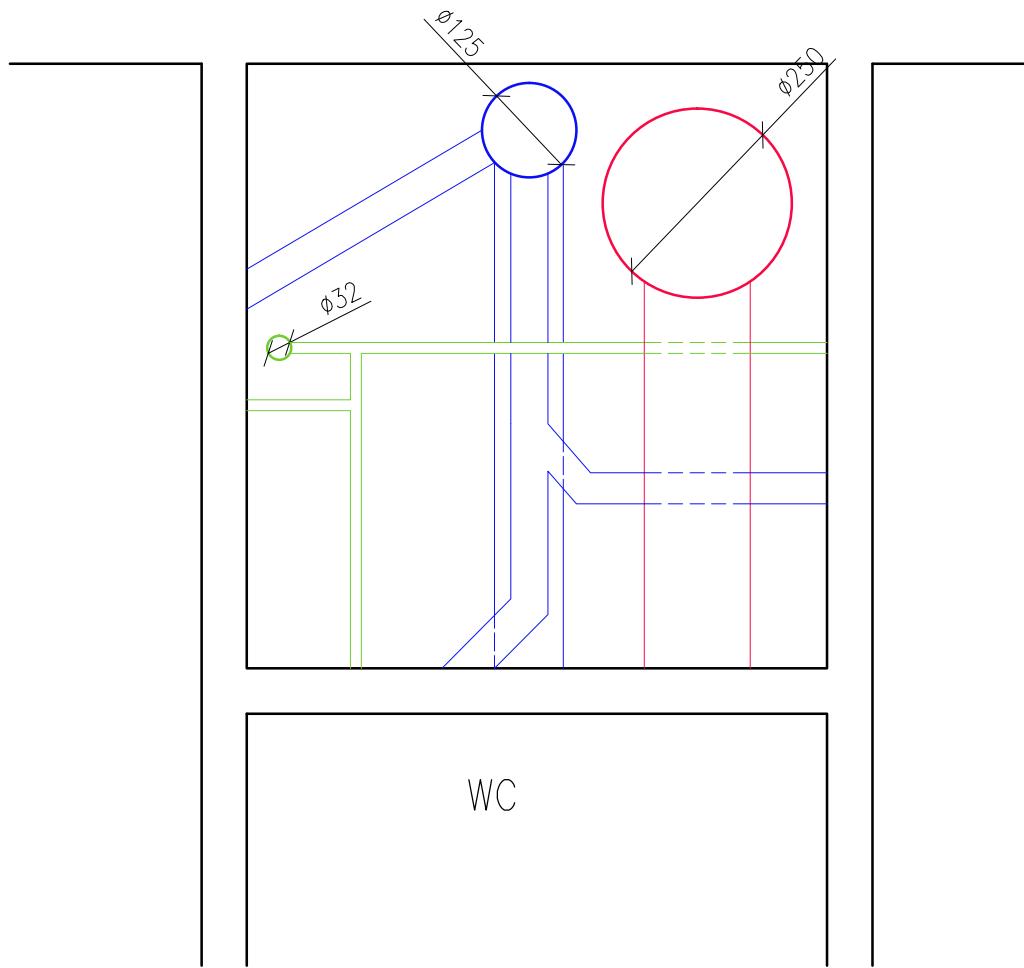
# DETAIL PROSTUPU NASÁVACÍHO POTRUBÍ – VARIANTA B, M 1:10
